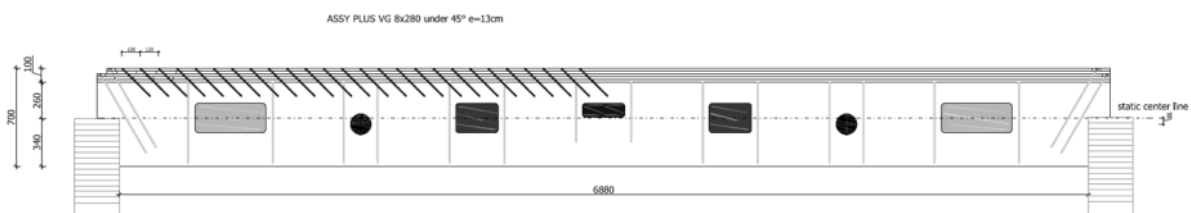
Deckenschnitt, Rippe mit TGA-Öffnungen (Quelle: ZÜBLIN Timber)
